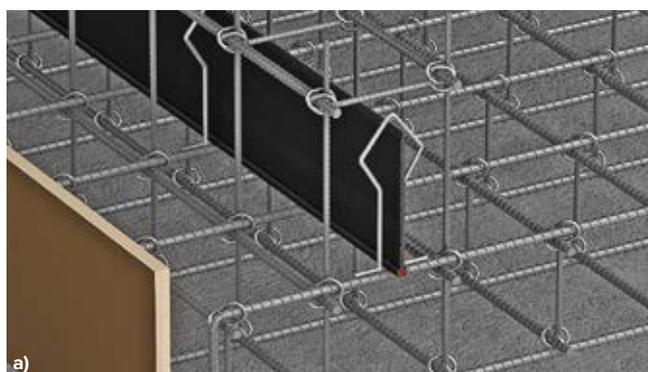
Этапы работ по установке гидрошпонок серии ТН Фундамент ТПС
